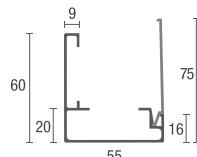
DETAIL UPEVNĚNÍ SPOJOVACÍHO PROFILU
